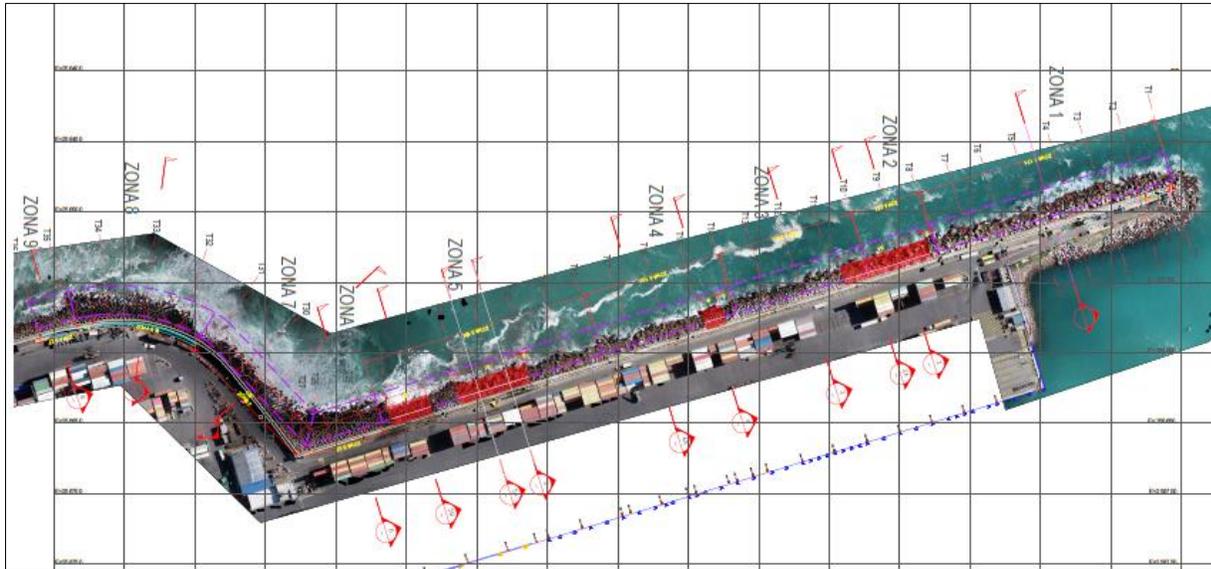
Planta de Recarga de roca en la escollera de Molo Sur, Puerto San Antonio.
